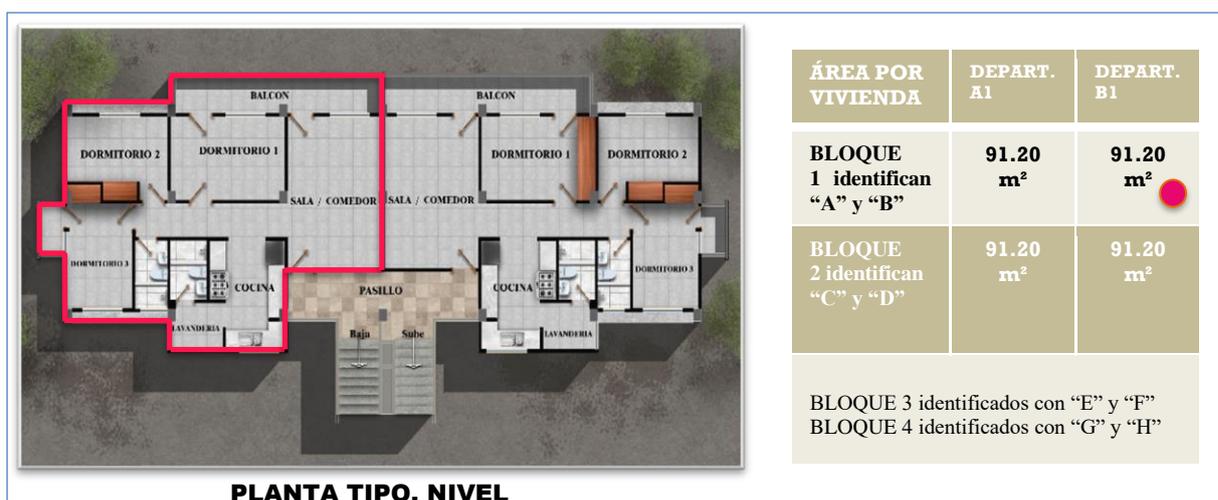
Área de la planta arquitectónica del modelo tipo Lineal.
